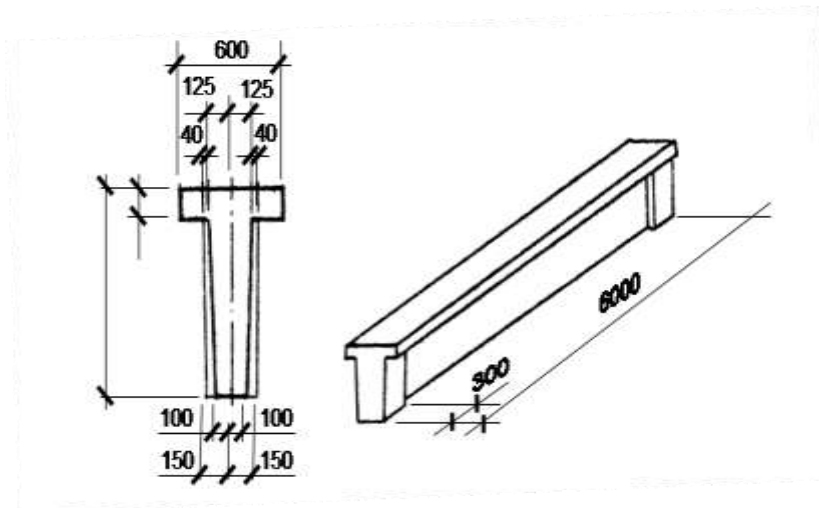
Подкрановая балка для шага колонн 6 м
